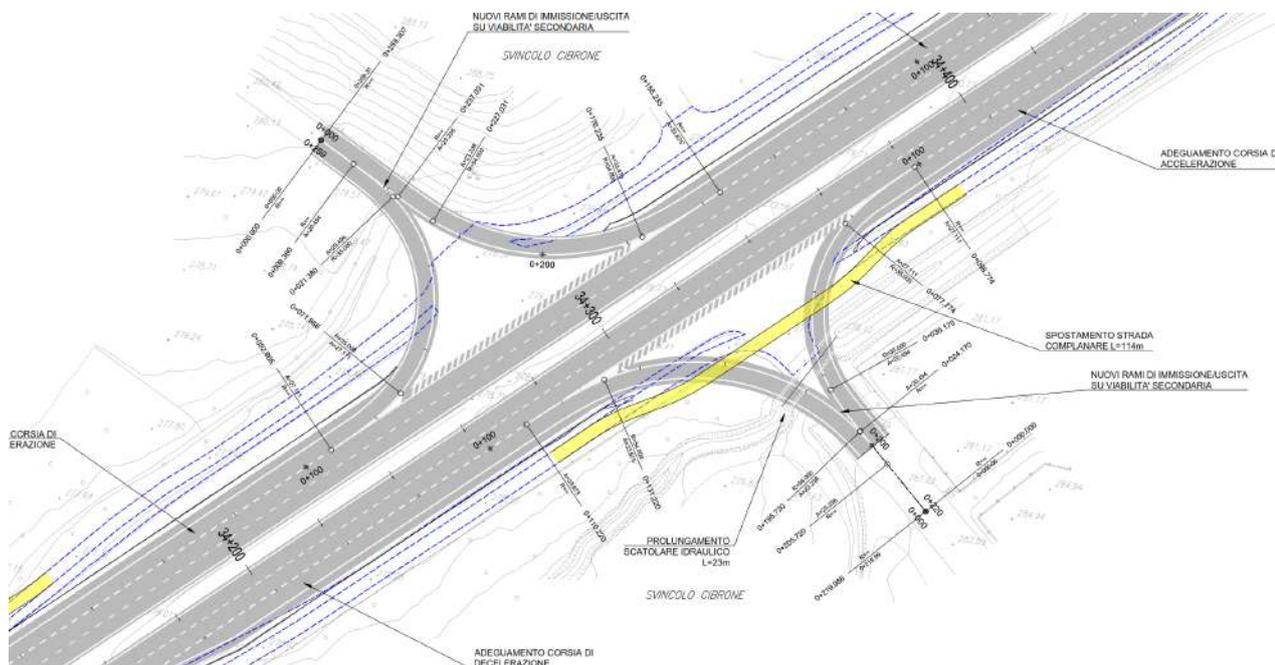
Stralcio planimetrico soluzione progettuale dello svincolo di Cibrone
